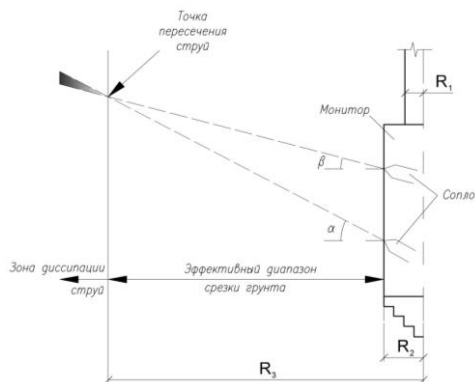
Схема конструкции монитора для определения зоны закрепления.
